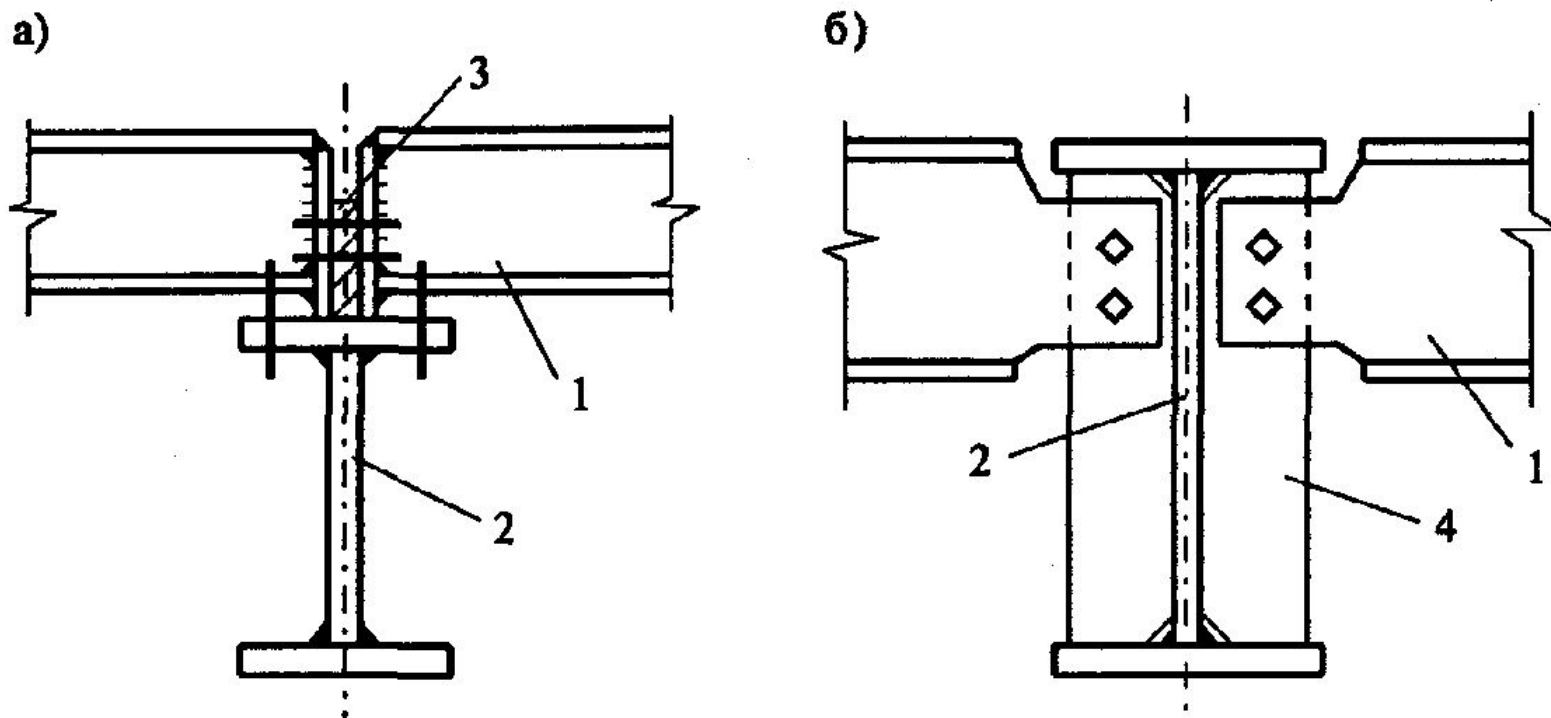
Узлы опирание балок настила на главную балку:
